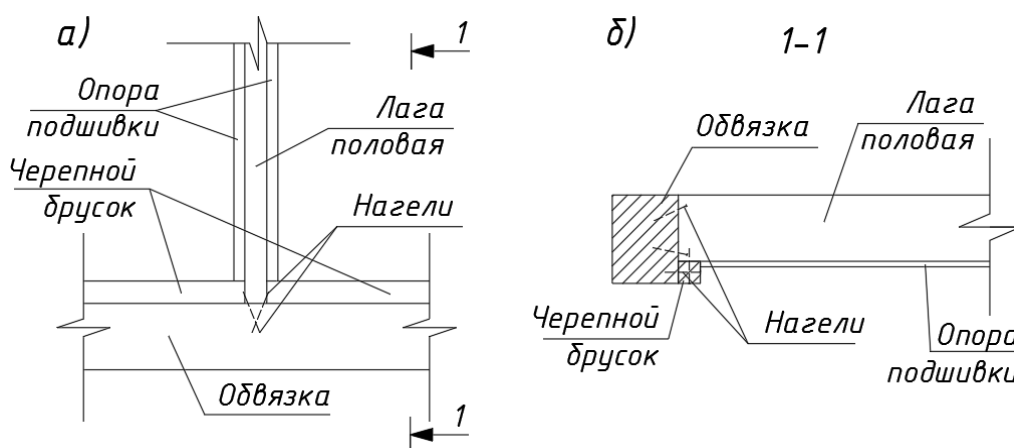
а) Узел соединения лаги с обвязочной балкой б) Разрез 1-1
